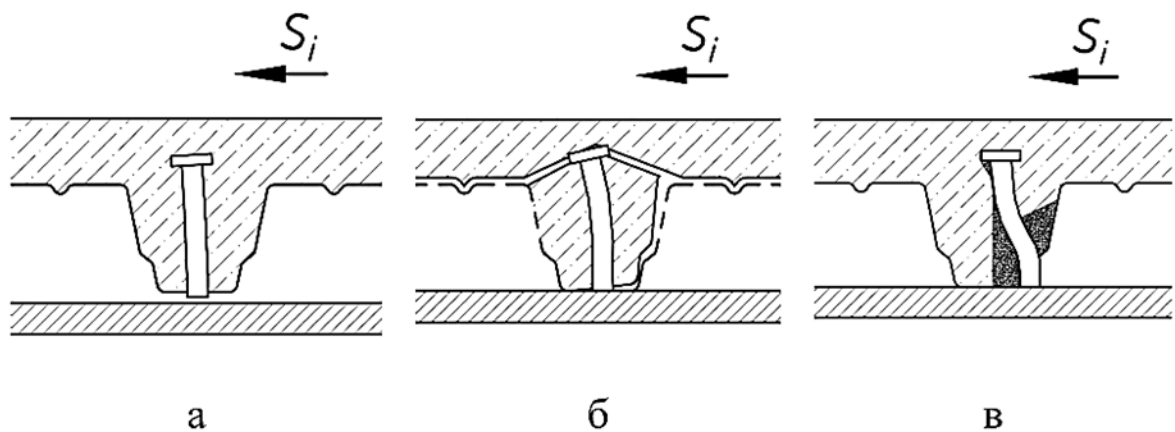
Найбільш характерні механізми руйнування анкерних в'язів в сталезалізобетонних балках. а - зріз анкерного упору; б - вирив з бетону зі зрізом ребра; в - продавливання бетонного ребра
